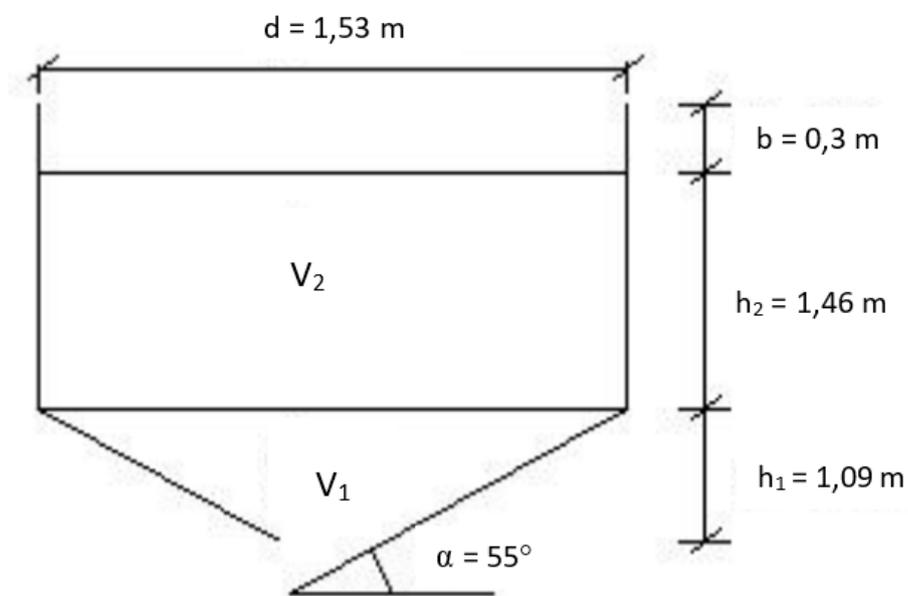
Alzado decantador de un tanque Imhoff. [fuente propia]
